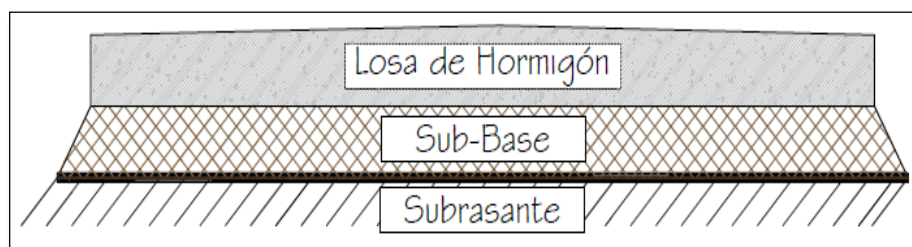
Sección Típica Transversal Pavimento Rígido
